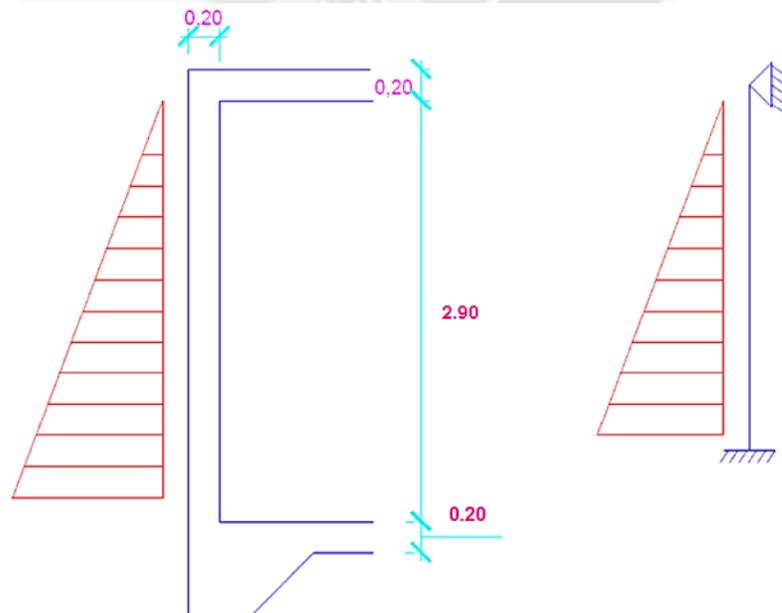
Sección e Idealización del Muro de la Cisterna a Diseñar.
